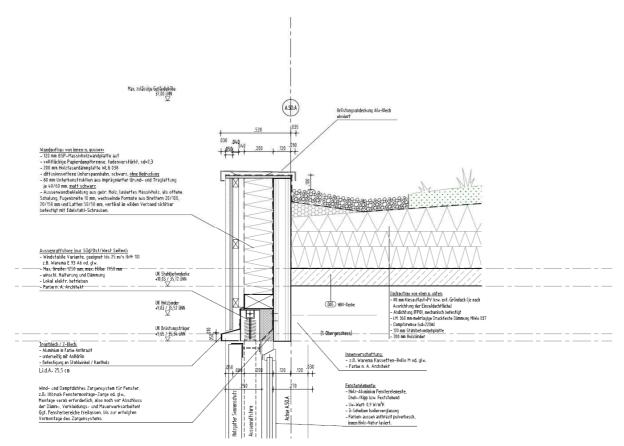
Fassadenschnitt - Attikadetail mit oberem Fensteranschluss (IBUS Architekten)
